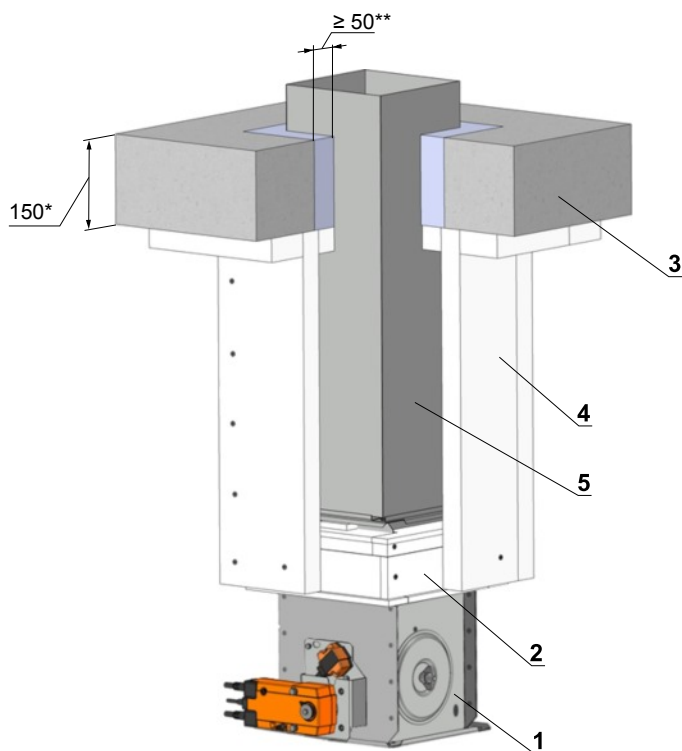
Mimo tuhou stropní konstrukci - beton a instalační rám E4 a R5
